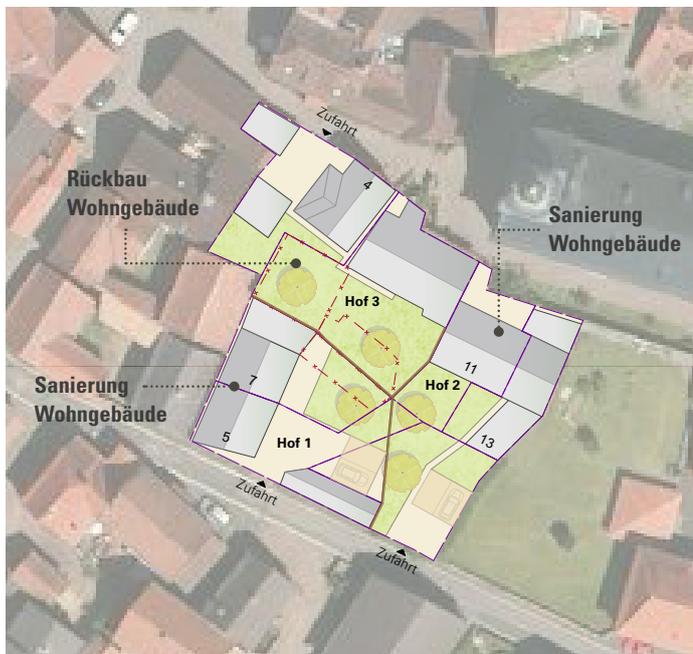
Lageplan - Weiterentwicklung der Hofstruktur 6 (Variante 1)
